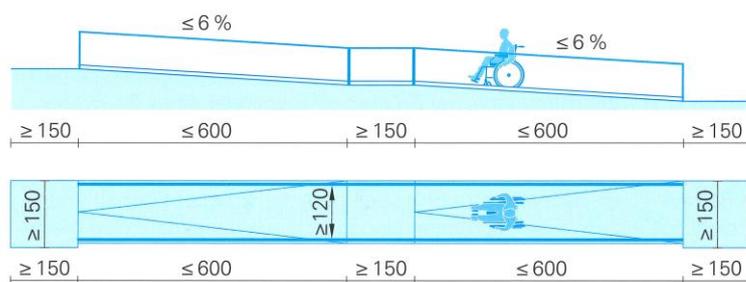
Grundriss und Ansicht einer zweiläufigen Rampe
